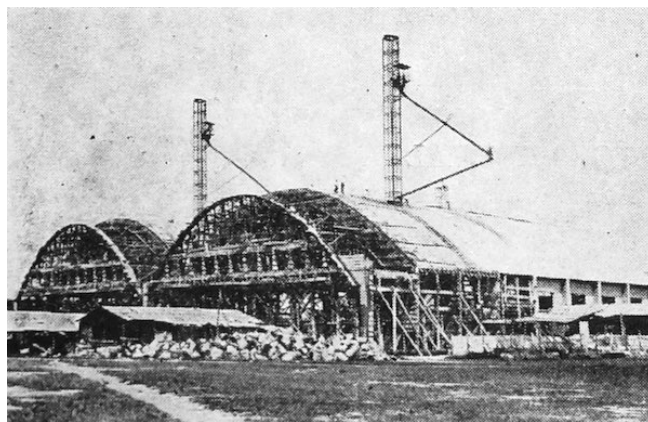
Hangares em construção. FONTE: CONCRETO, 1938.
